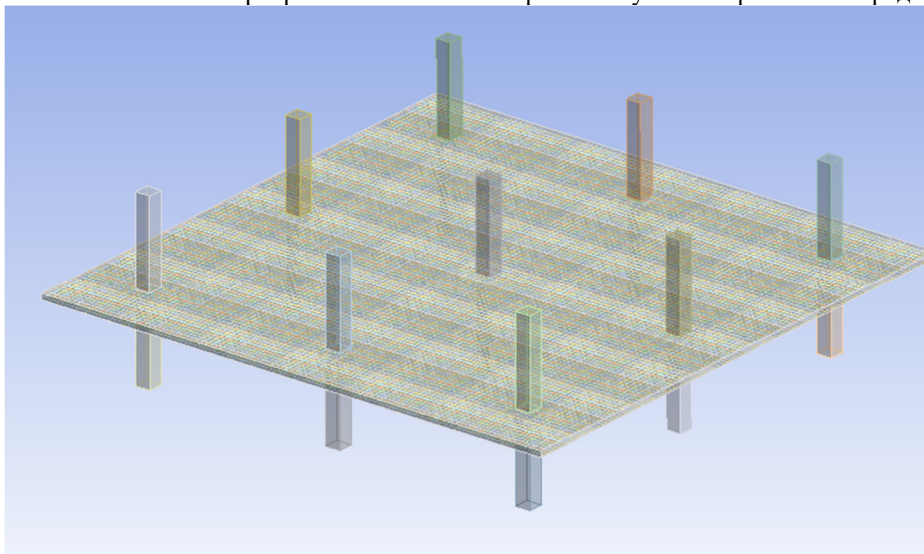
Расчетная схема безбалочного монолитного перекрытия в расчетной среде Ansys
